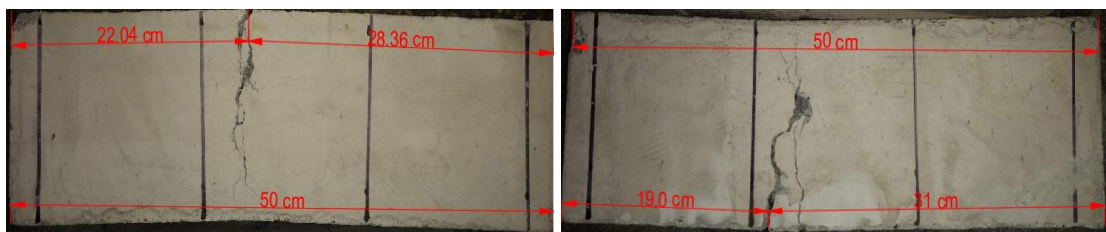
Modos de falla de las vigas ($Vf - 3$) y ($Vf - 4$) del espécimen 2 con FA ($Ef - 3$).
